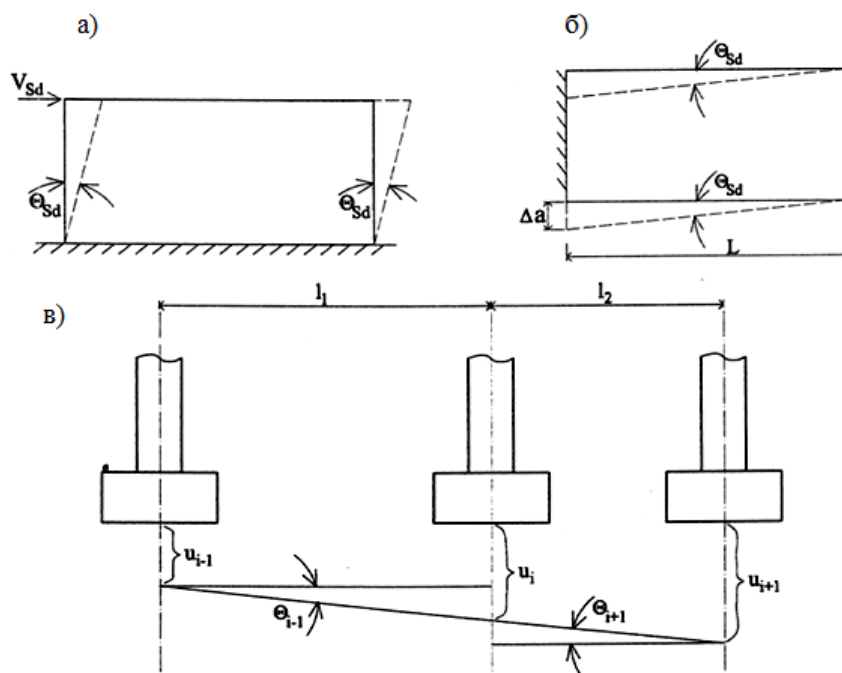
Перекос каменной кладки при горизонтальном (а) и вертикальном (б) сдвиге и способ определения величины θ_{sd} при неравномерных осадках фундаментов [5]
